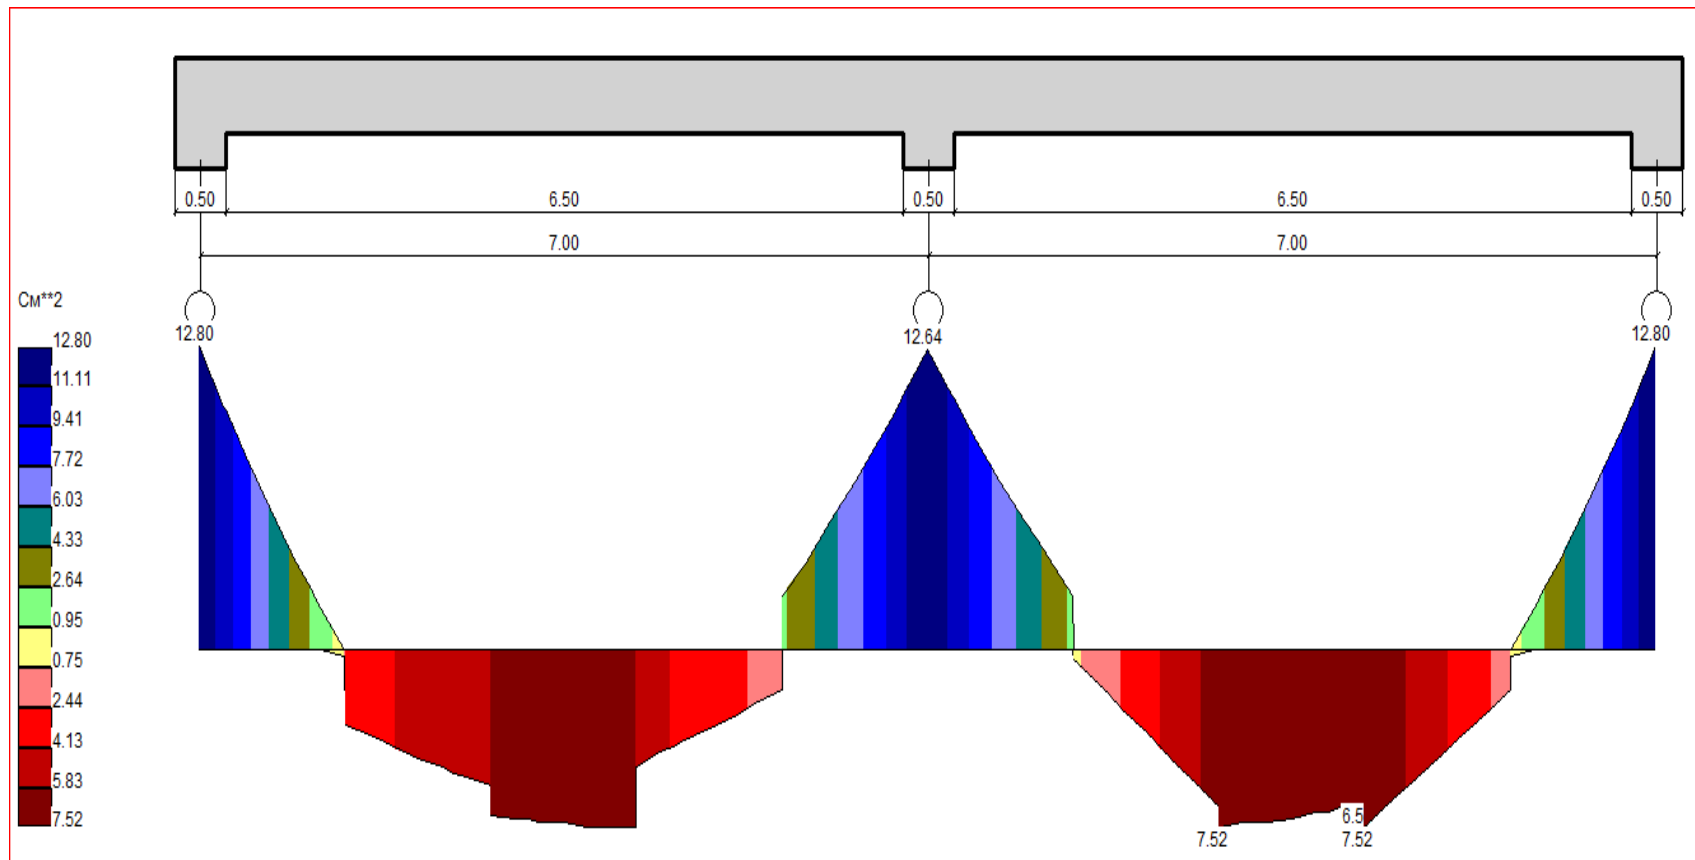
Варіант балково-плитного перекриття. Балка 1-9. Епюра розрахункового продовжного армування
